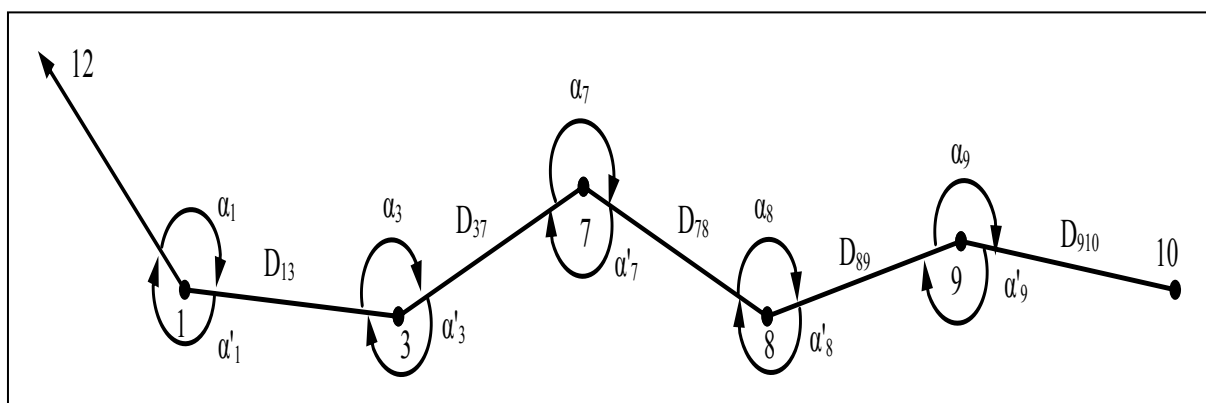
Drumuirea planimetrică flotantă parcursă „dus – întors”
